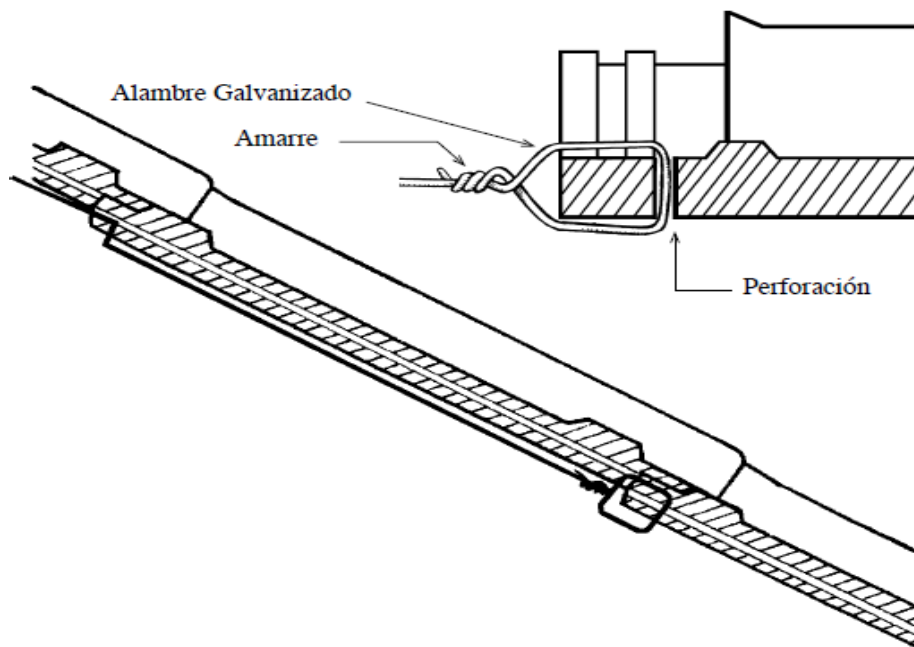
Amarre de las tejas (Onduline, 2019)
